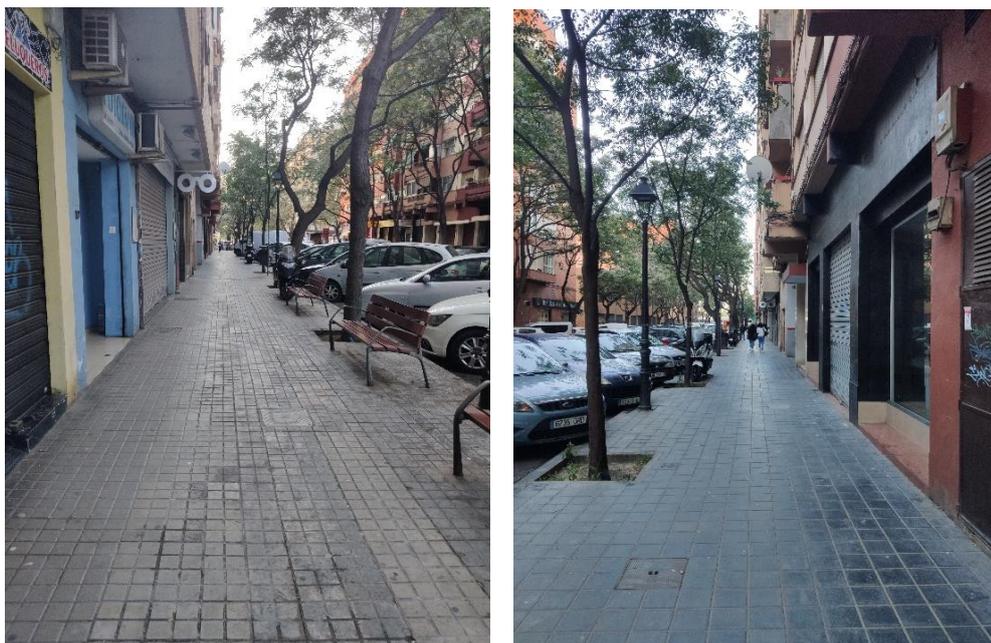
Pavimentos calle José Andreu Alabarta, Pavimento 1 (izquierda) y Pavimento 2 (derecha).
